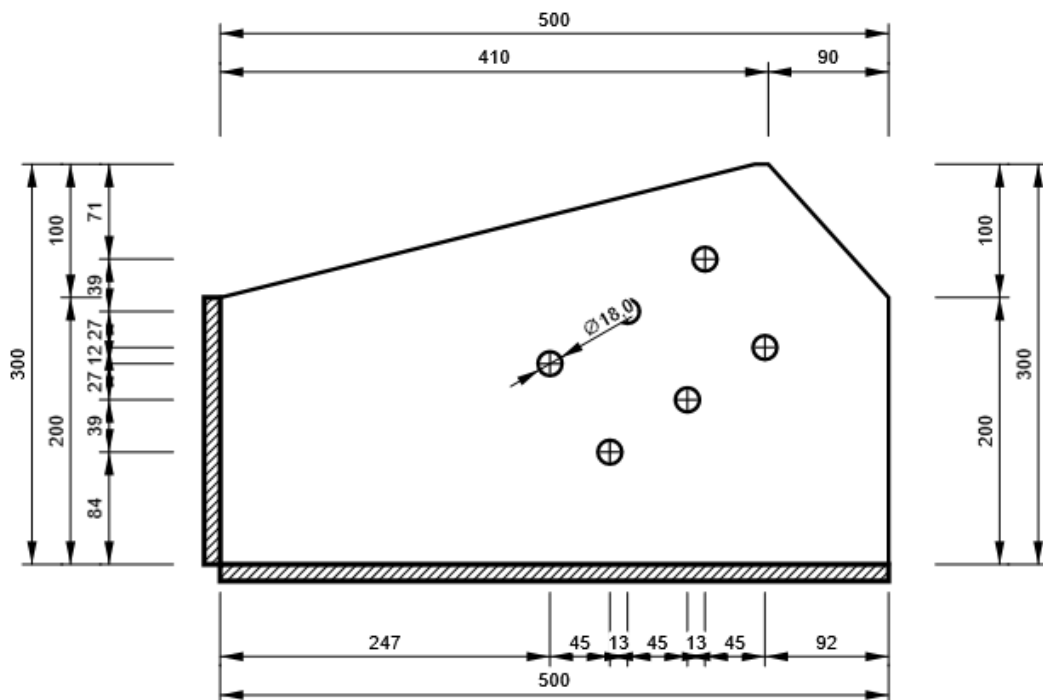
Dimensions et disposition constructive des boulons et des cordons de soudures sur le gousset.
